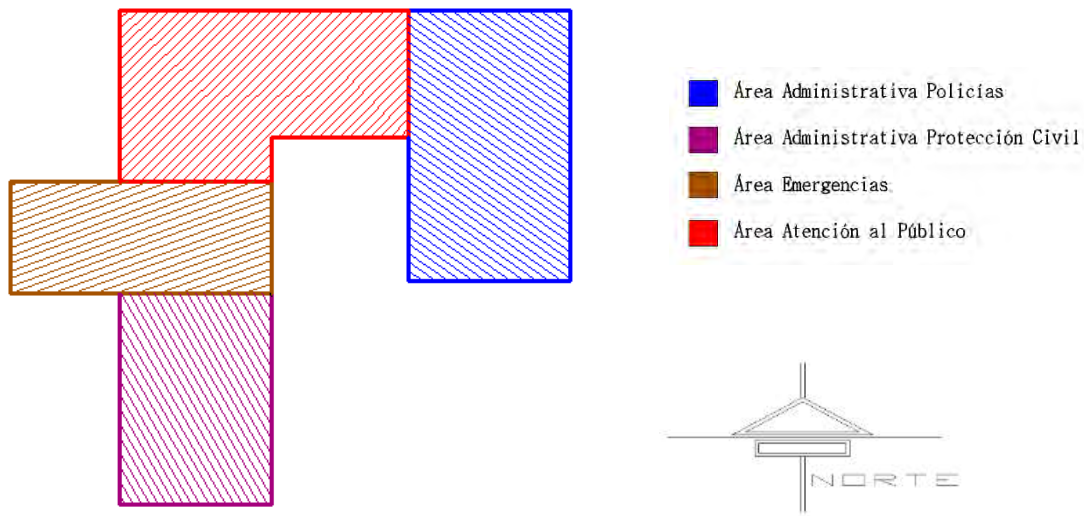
zonificación planta baja de estación de policías y protección civil (fuente propia)
